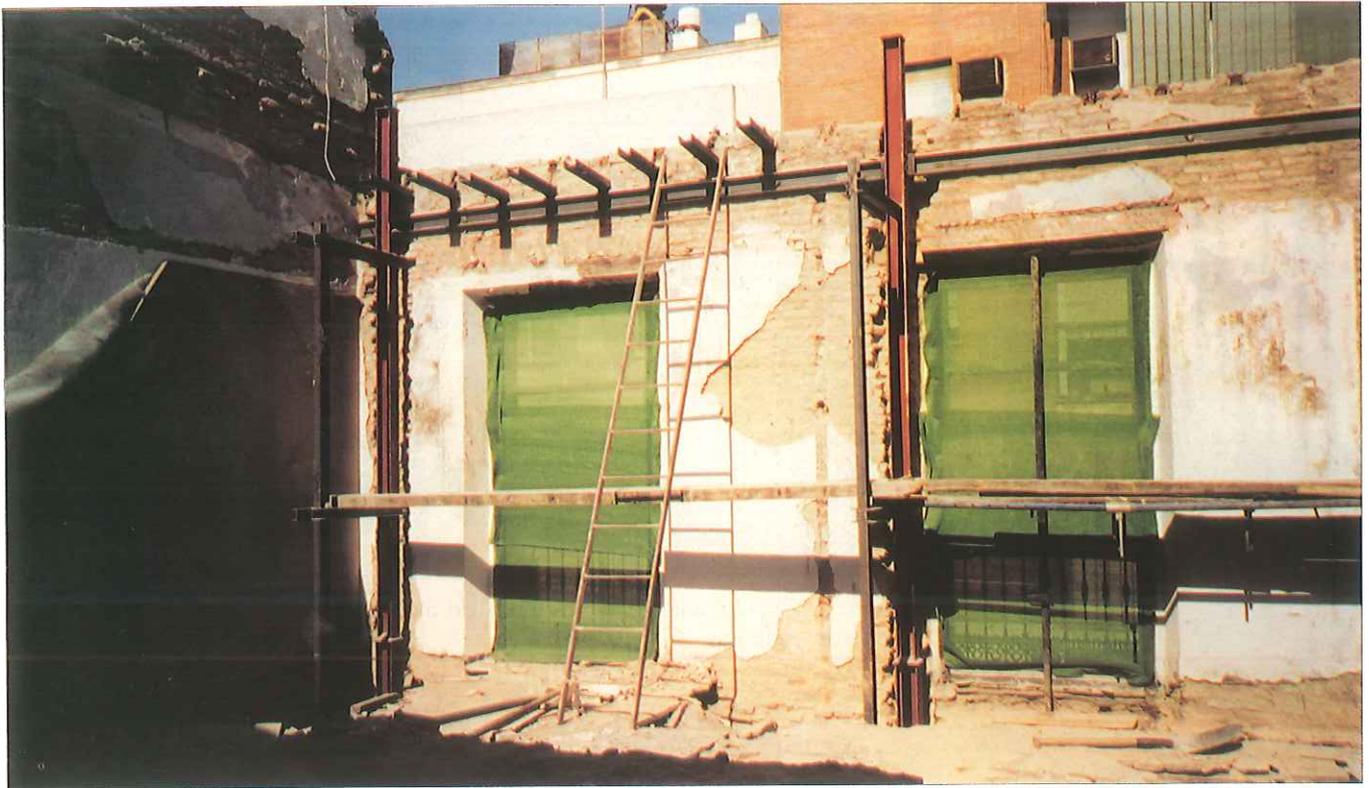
Implantación del sistema de arriostramiento de los muros durante la fase de demolición.
